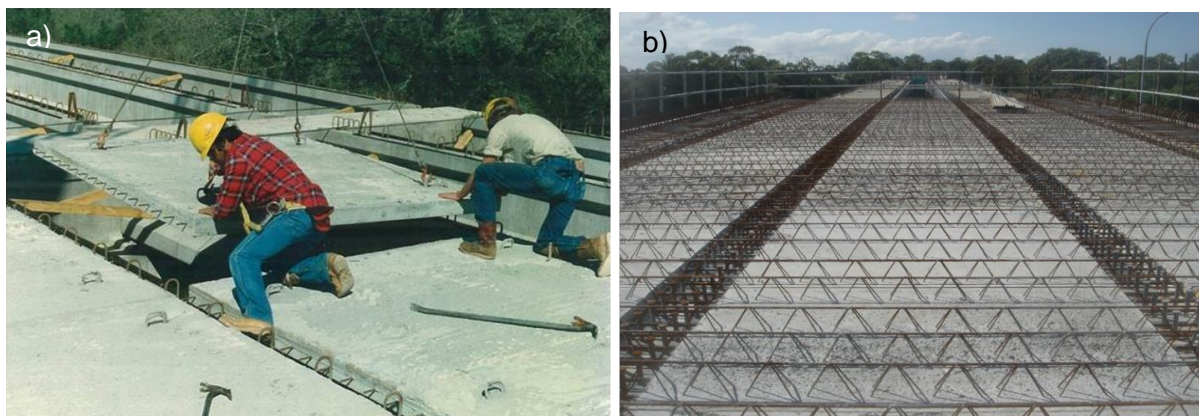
Tipos de pré-lajes. a) Pré-lajes de betão armado. b) Pré-lajes participantes. Fonte: ABC-UTC 2018 e Humes.
